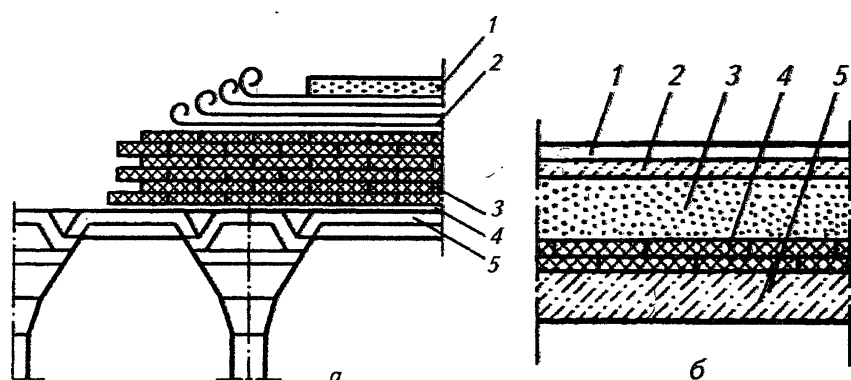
Изоляционные конструкции покрытий холодильника:
